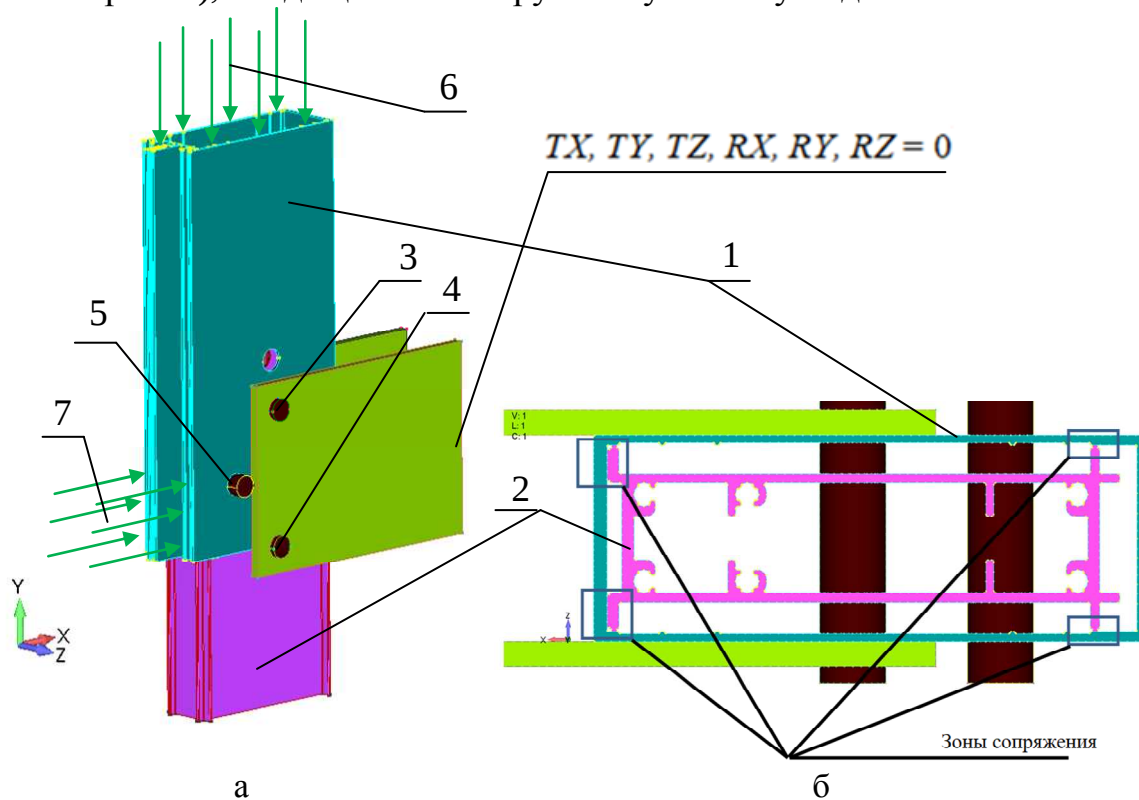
Расчетная схема подвески стеклопакета: а – общий вид; б – вид сверху с указанием зон сопряжения стоек
